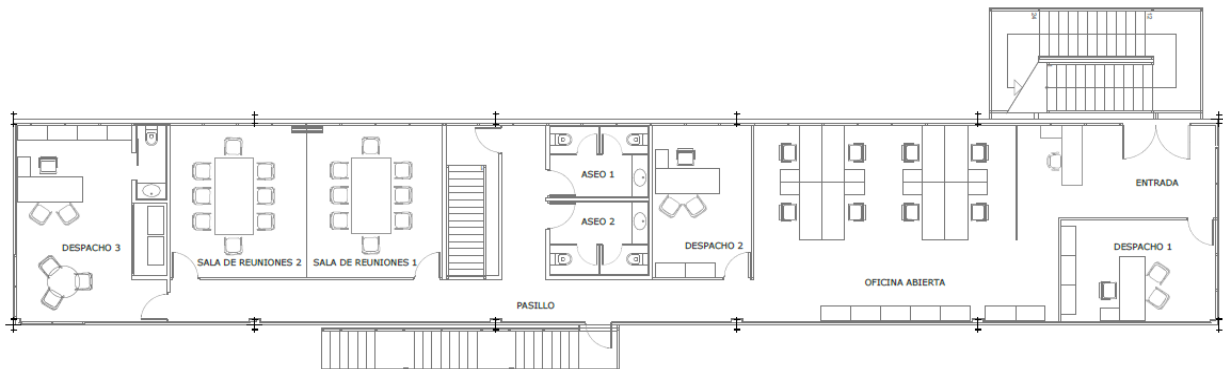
DISTRIBUCIÓN PLANTA 1 OFICINAS (PLANO 4)
